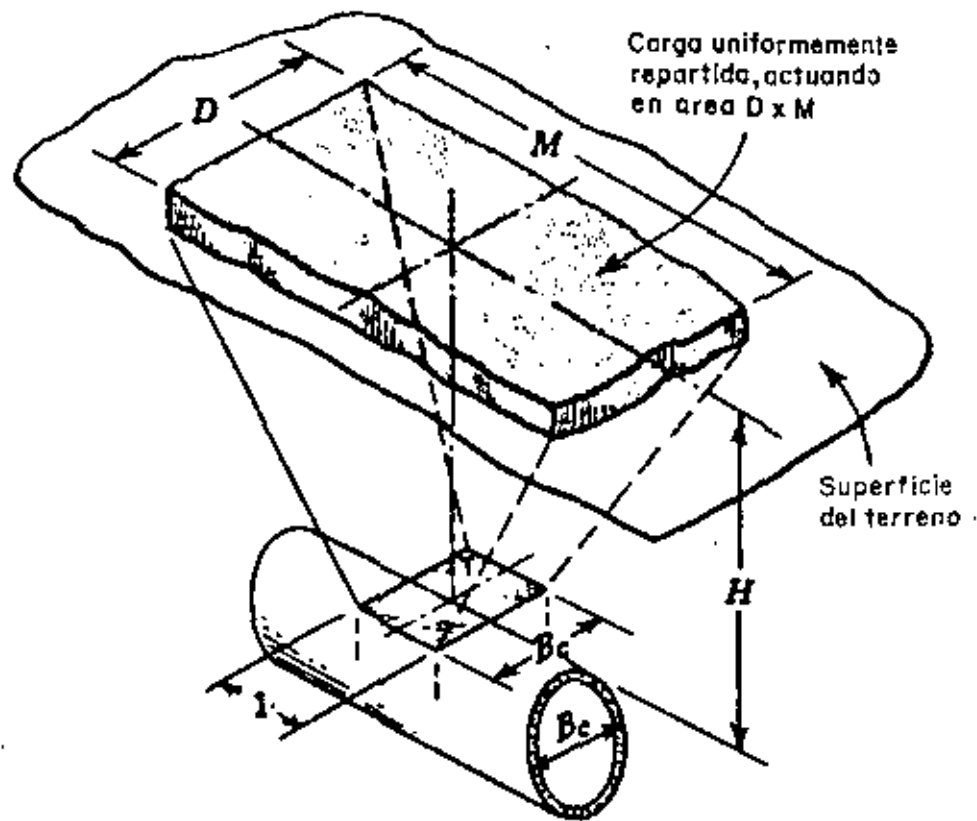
CARGA DISTRIBUIDA SOBREPUESTA CENTRADA VERTICALMENTE SOBRE EL CONDUCTO.
